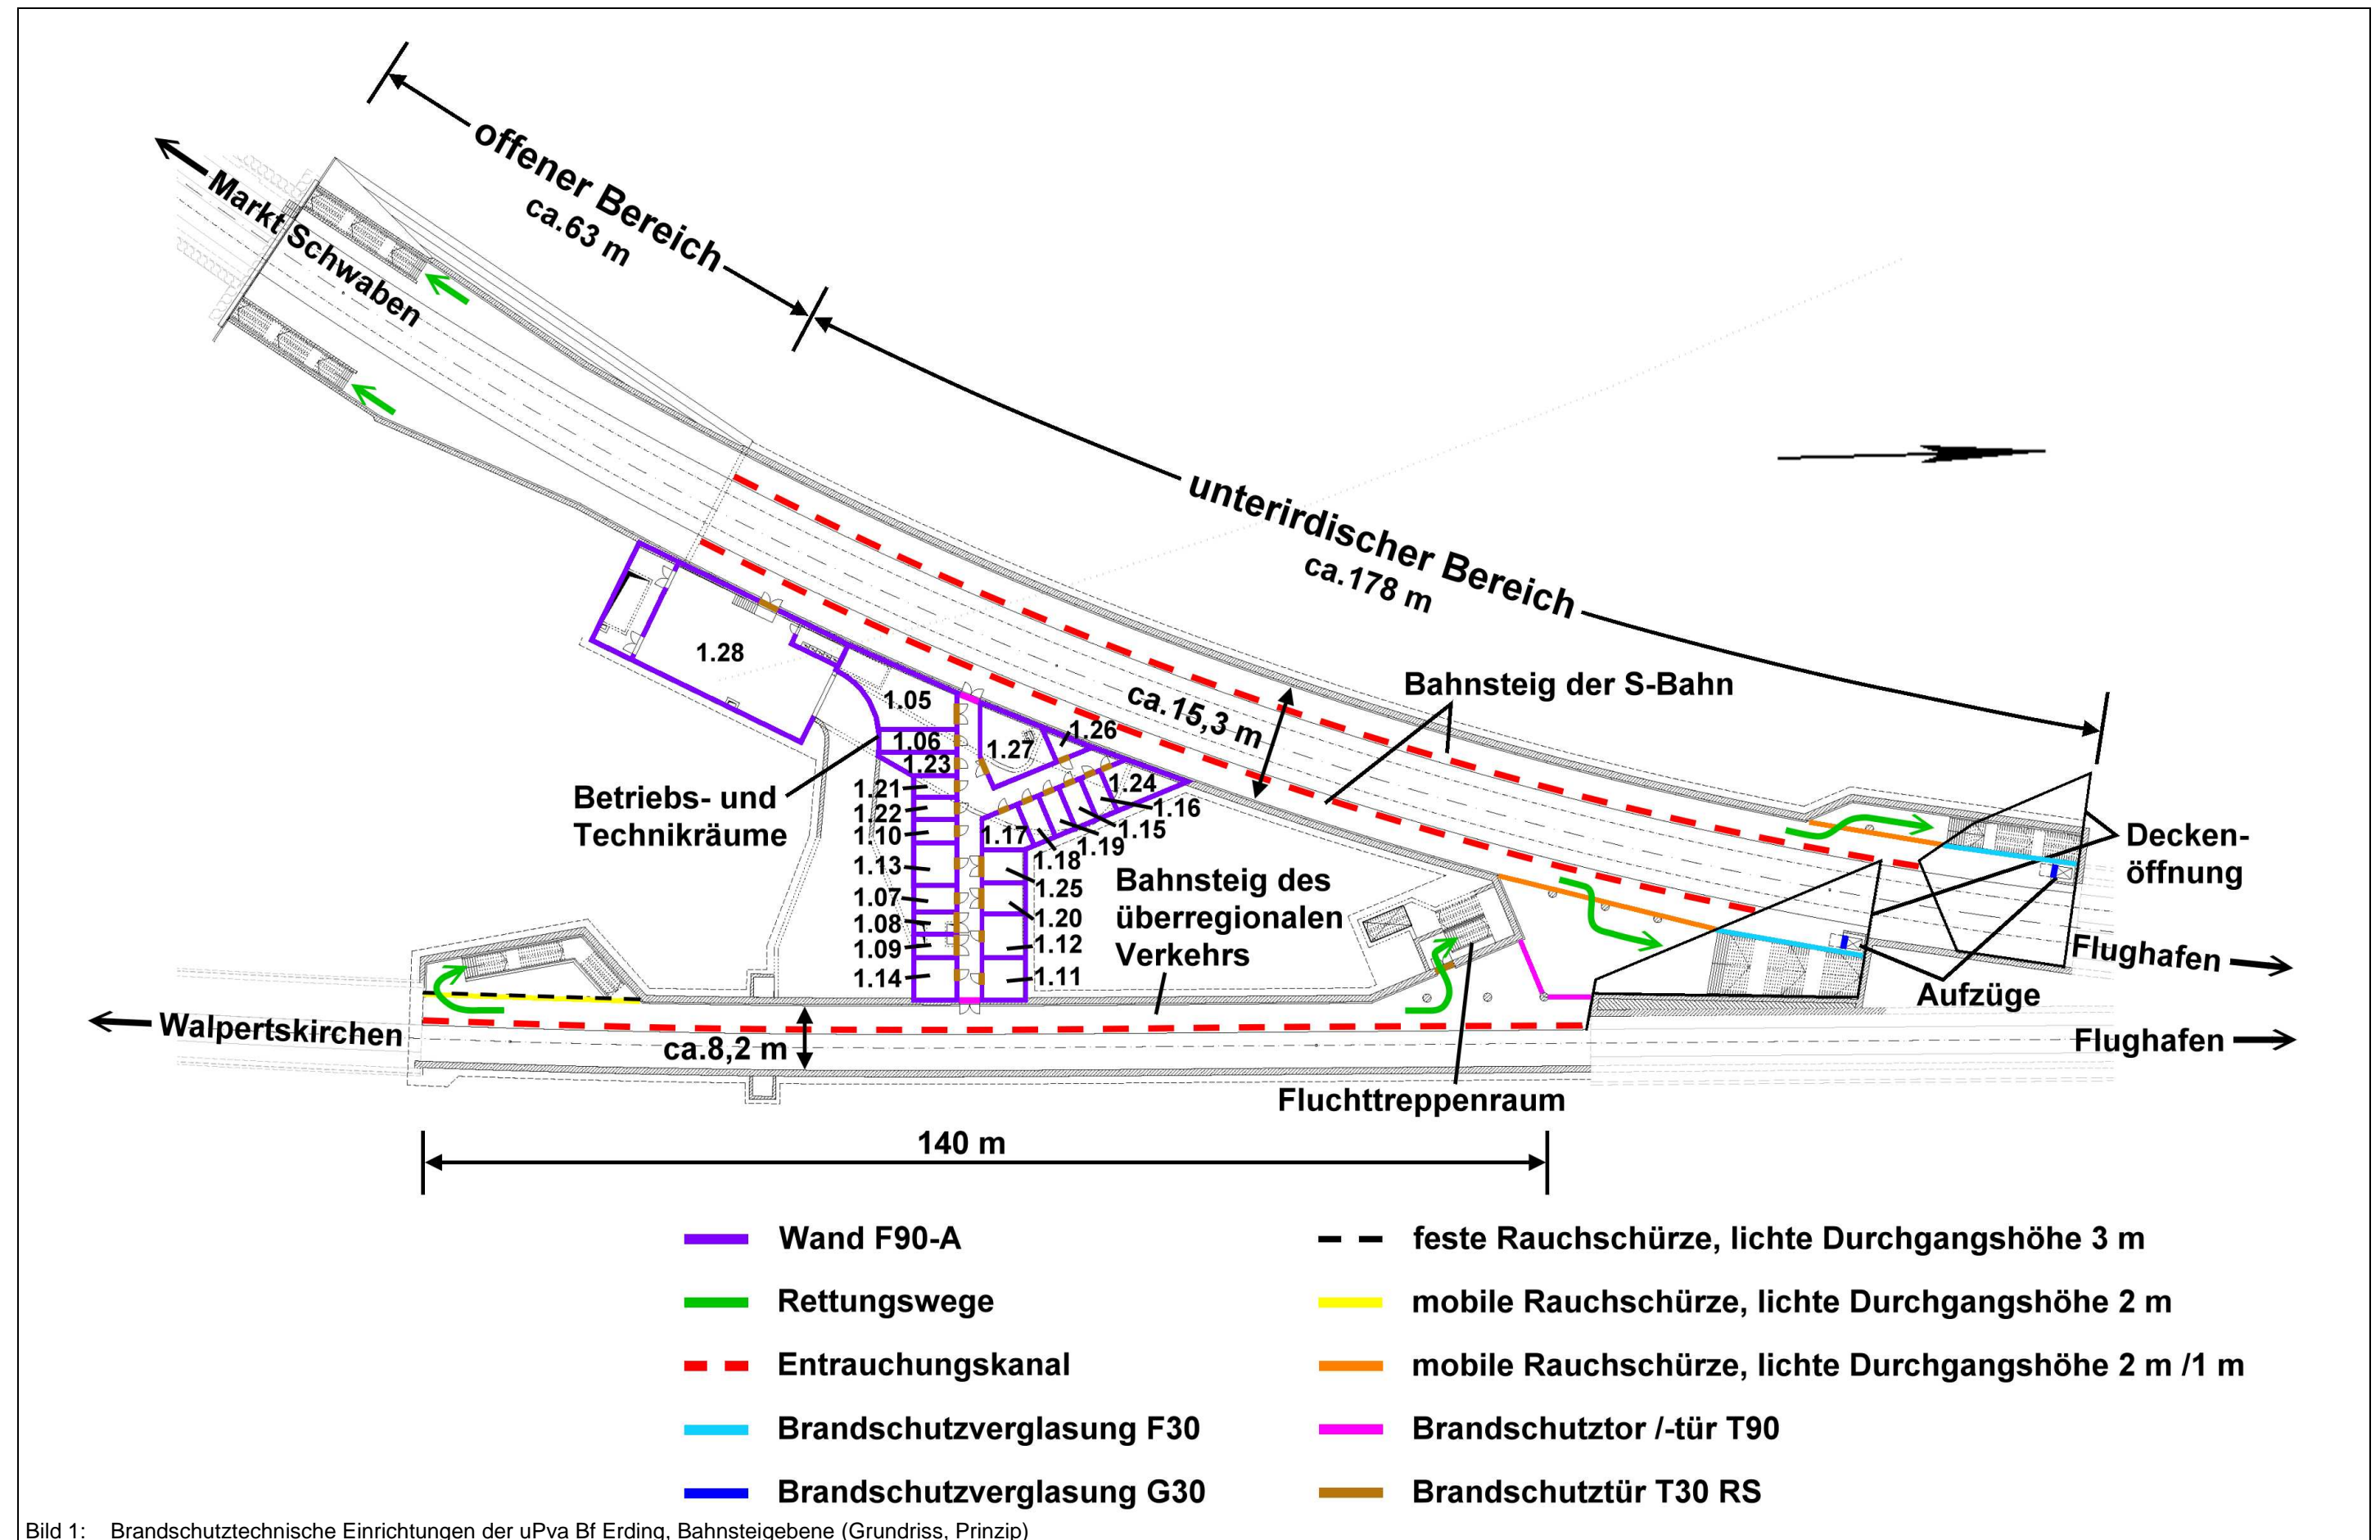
Brandschutztechnische Einrichtungen der uPva Bf Erding, Bahnsteigebene (Grundriss, Prinzip)
